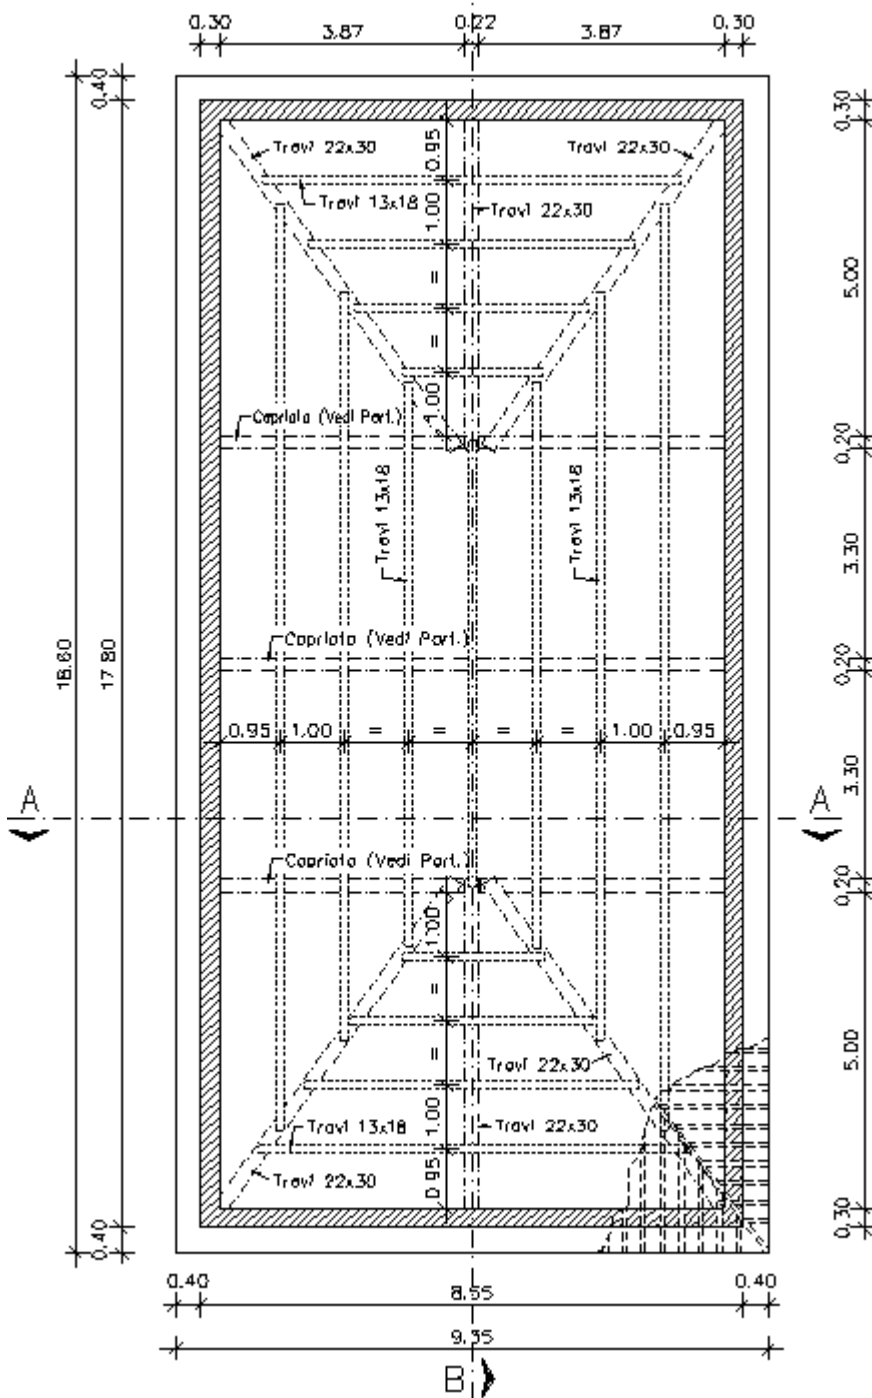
Ex-Lavanderie - : stato di progetto: pianta strutture di copertura
